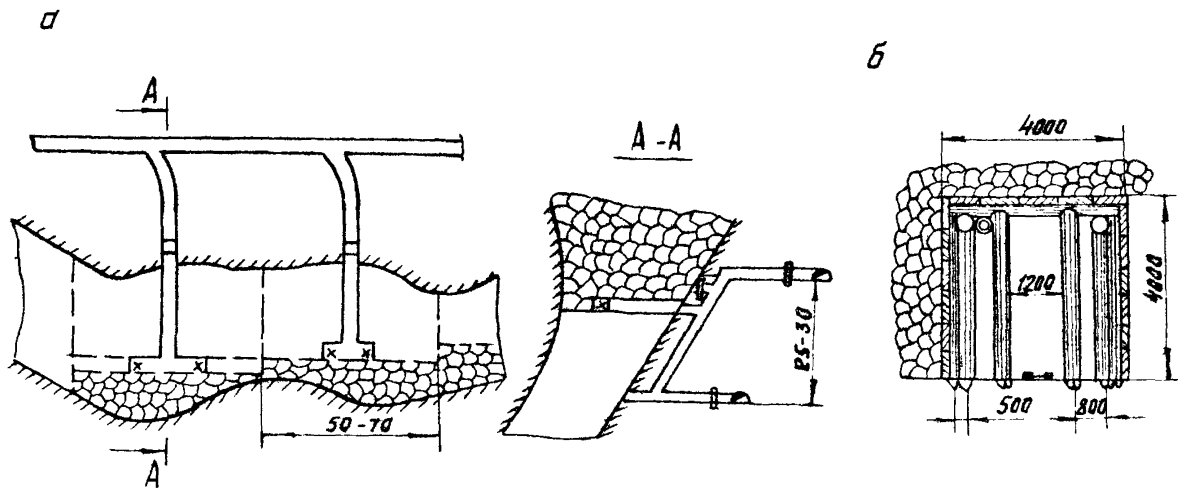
Схема выемки камерами апофея, расположенных со стороны кровли пласта:
